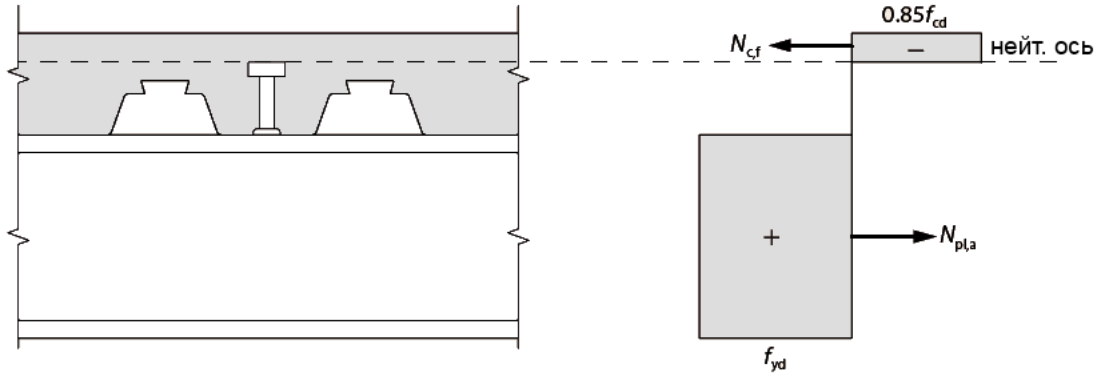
Распределения напряжений в пластической стадии на примере сталежелезобетонных балок со сплошными плитами
